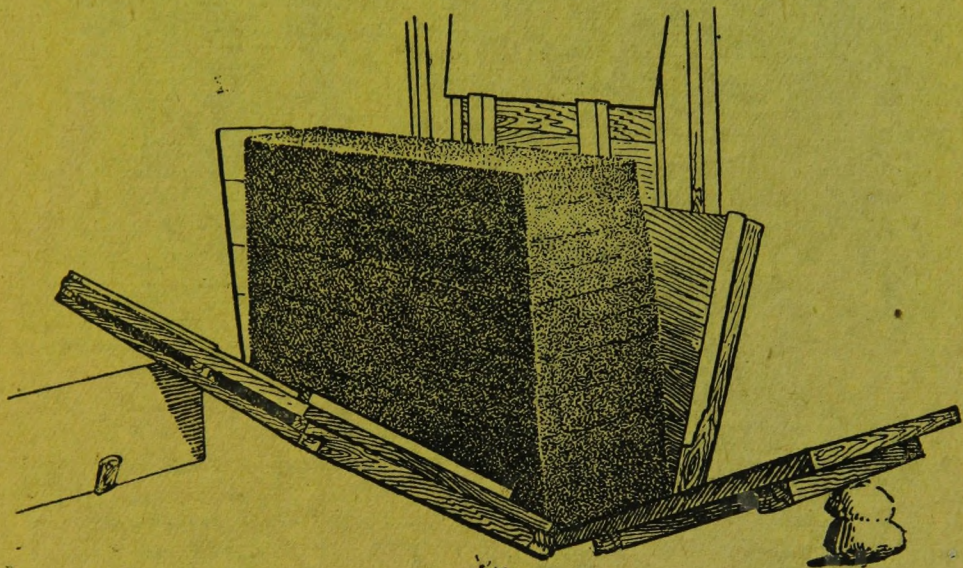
Пробная стенка с раскрытыми щитами опалубки.
